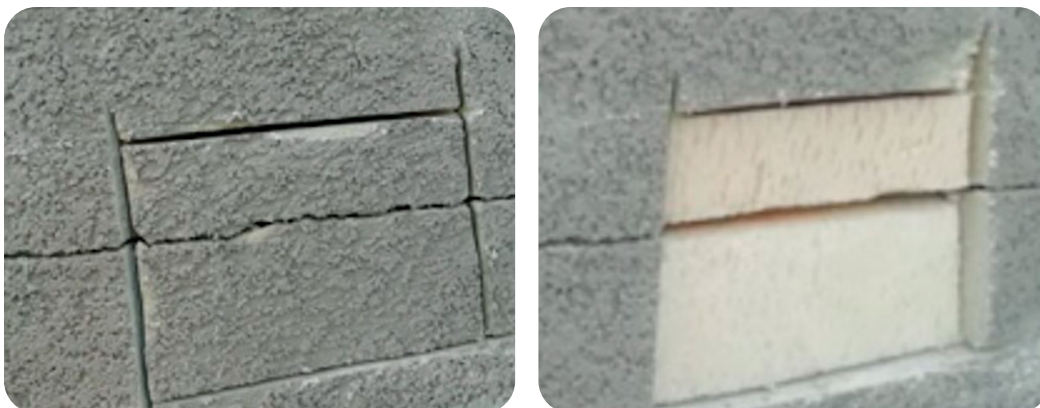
Grieta coincidente con separación entre paneles de aislamiento
